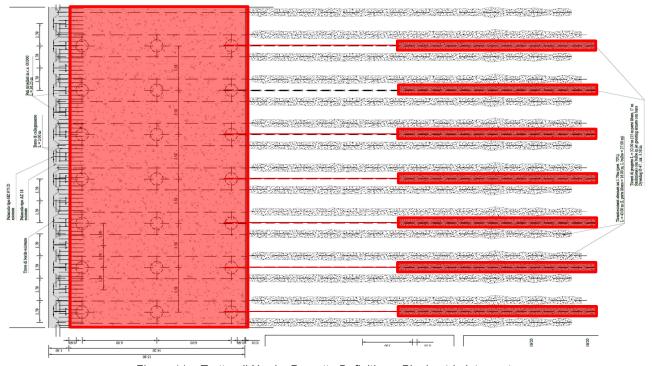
Trattaroli Nord – Progetto Definitivo – Planimetria intervento
